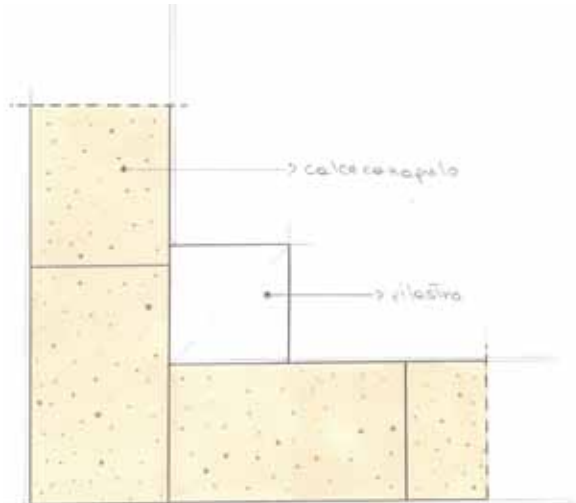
Sistema ad ossatura portante, interna rispetto alla muratura in blocchi
